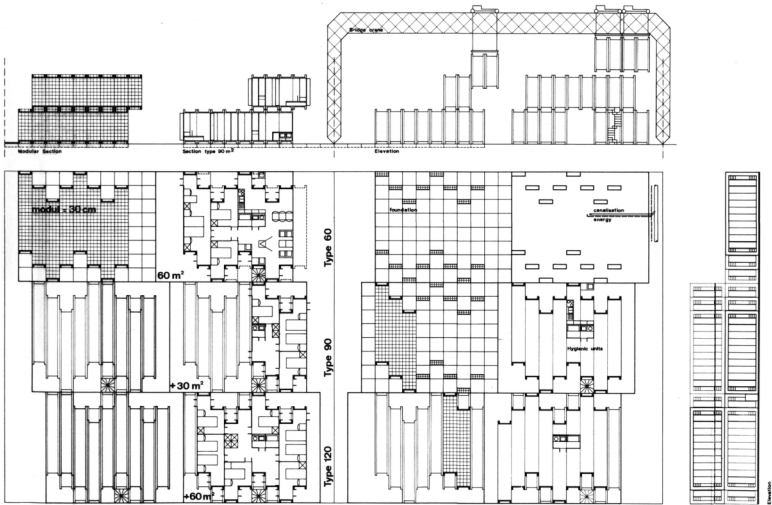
Bauprozess in Schnitt- und Grundrissprojektion
